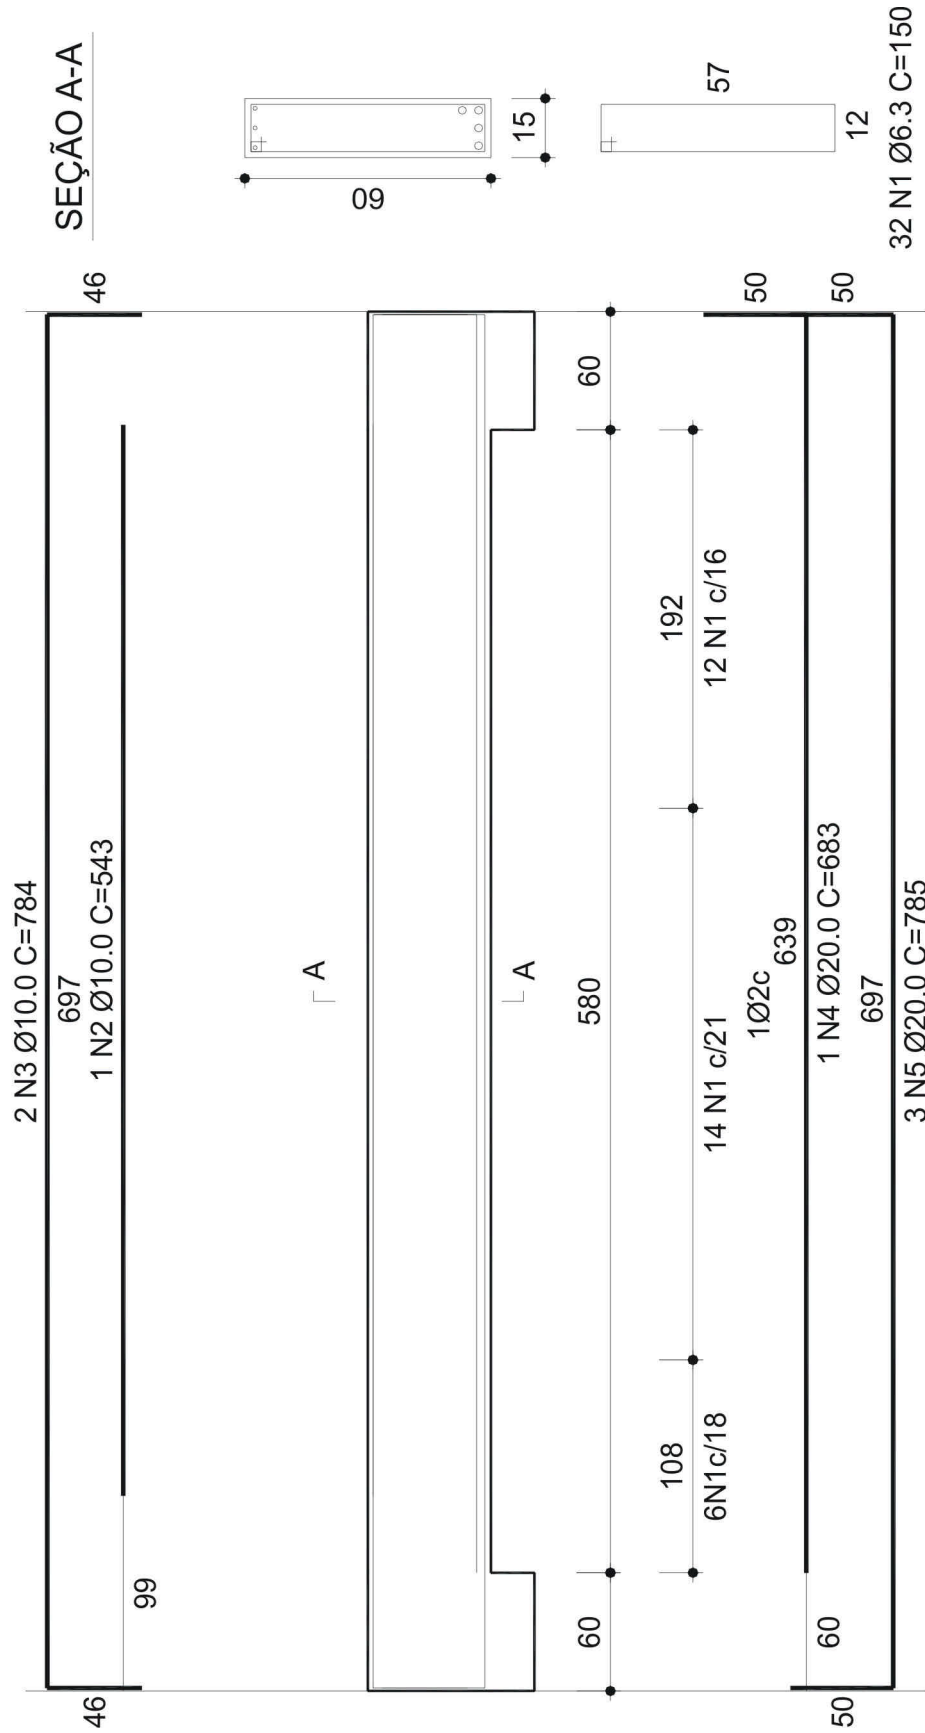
Detalhamento Viga 02, realizado pelo Eberick.
